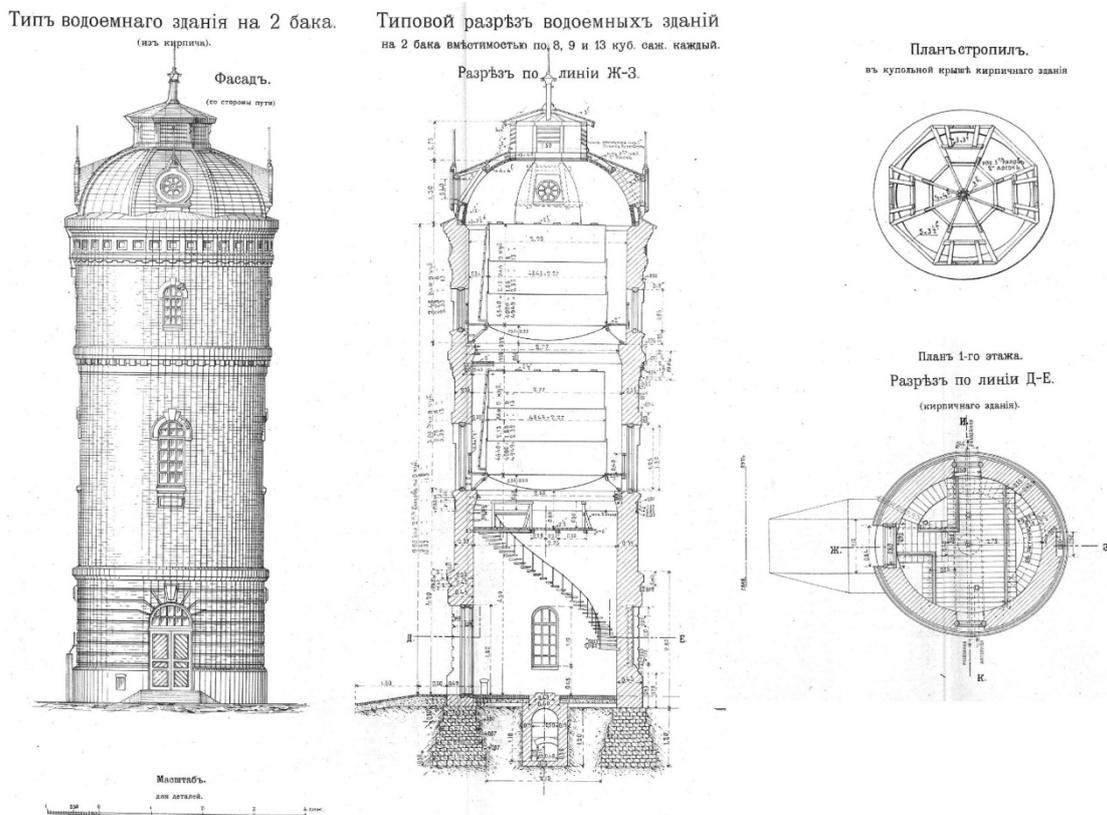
Водоемное здание на станции Полоцк Бологое-Полоцкой железной дороги
